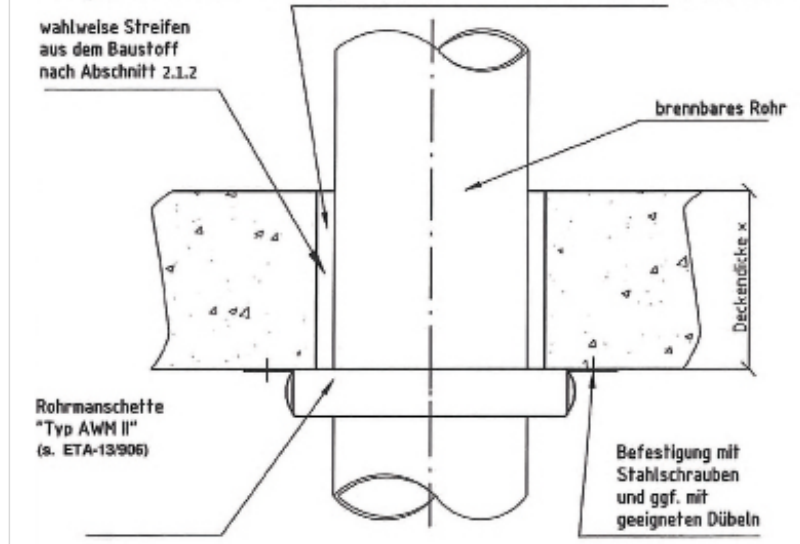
• Fachgerecht und zulässig ausgeführte Restspaltverschlüsse um Rohrleitungen sind wichtige Bestandteile des baulichen Brandschutzes.
